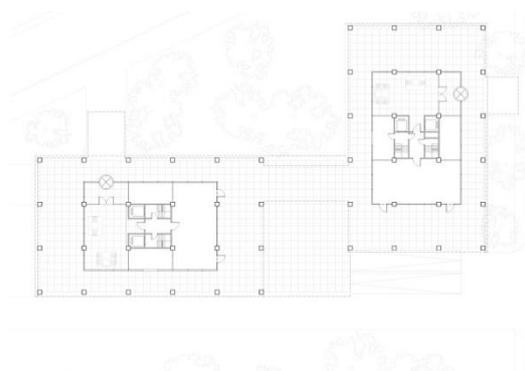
Planta piso terreo, (Krohn, 2011, p. 154).
